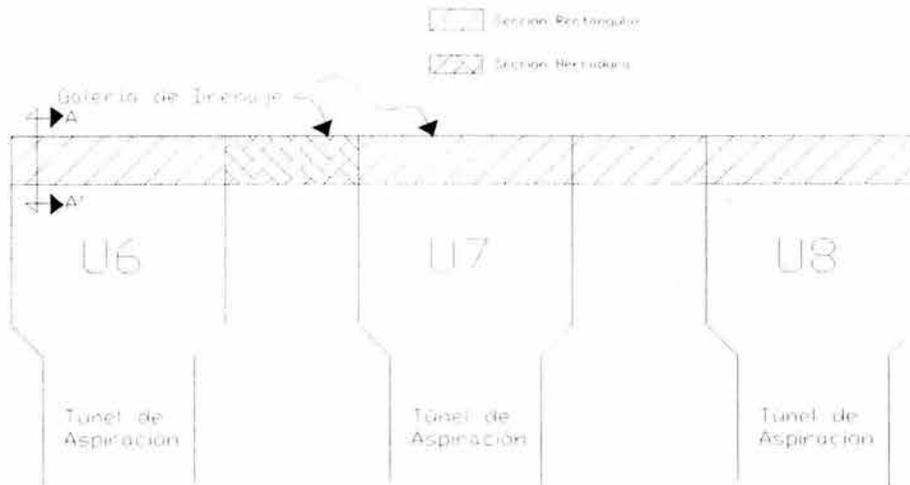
Vista en Planta de la Galería de Drenaje.
